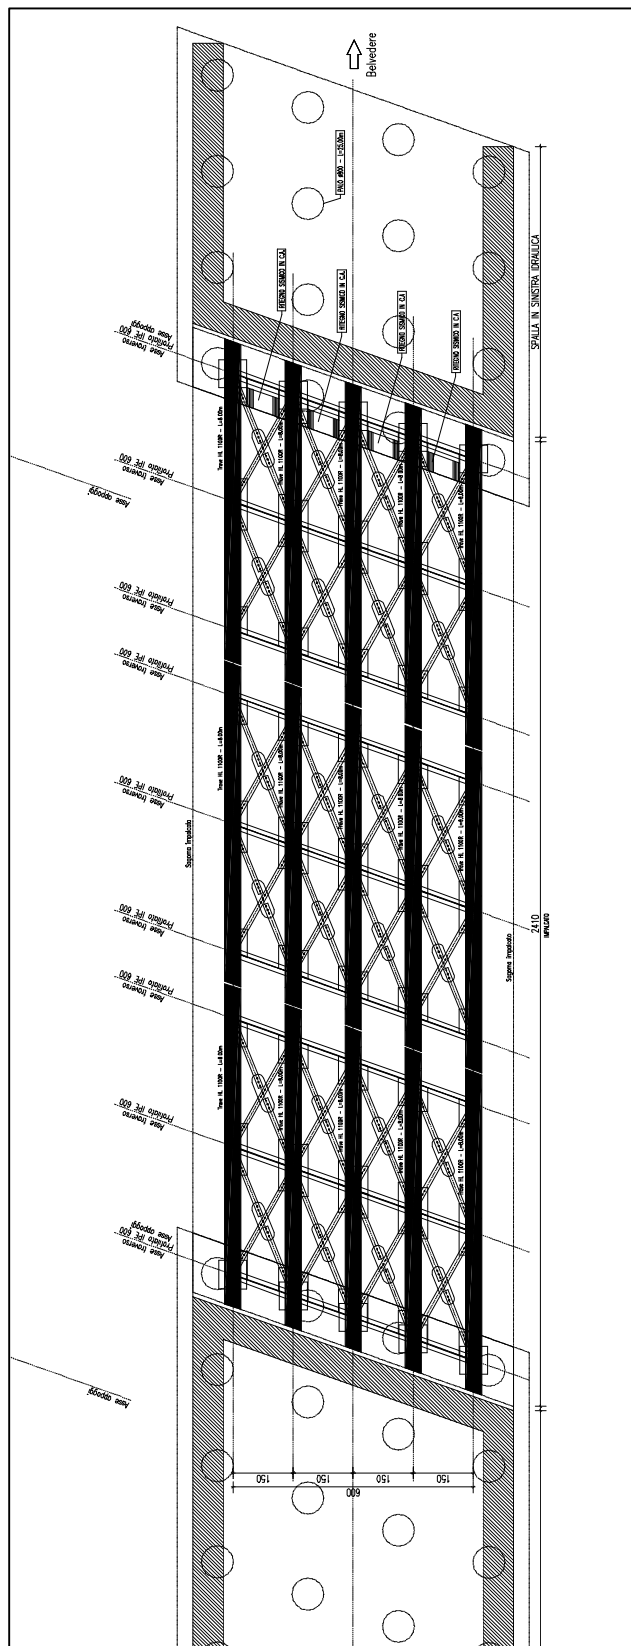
Pianta del ponte con indicazione delle fondazioni su pali e muri andatori in destra e sinistra idraulica
